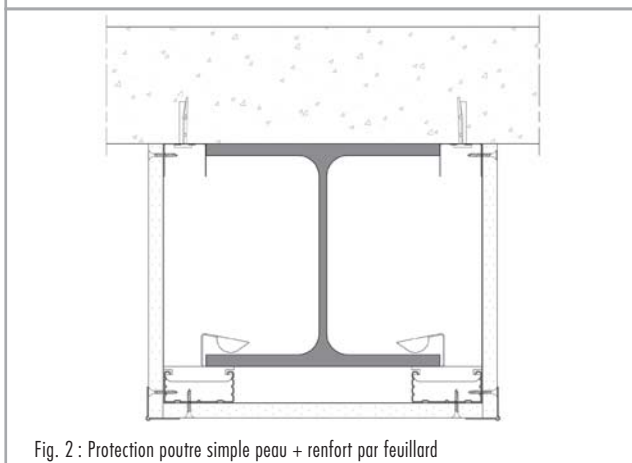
Protection poutre simple peau + renfort par feuilard
